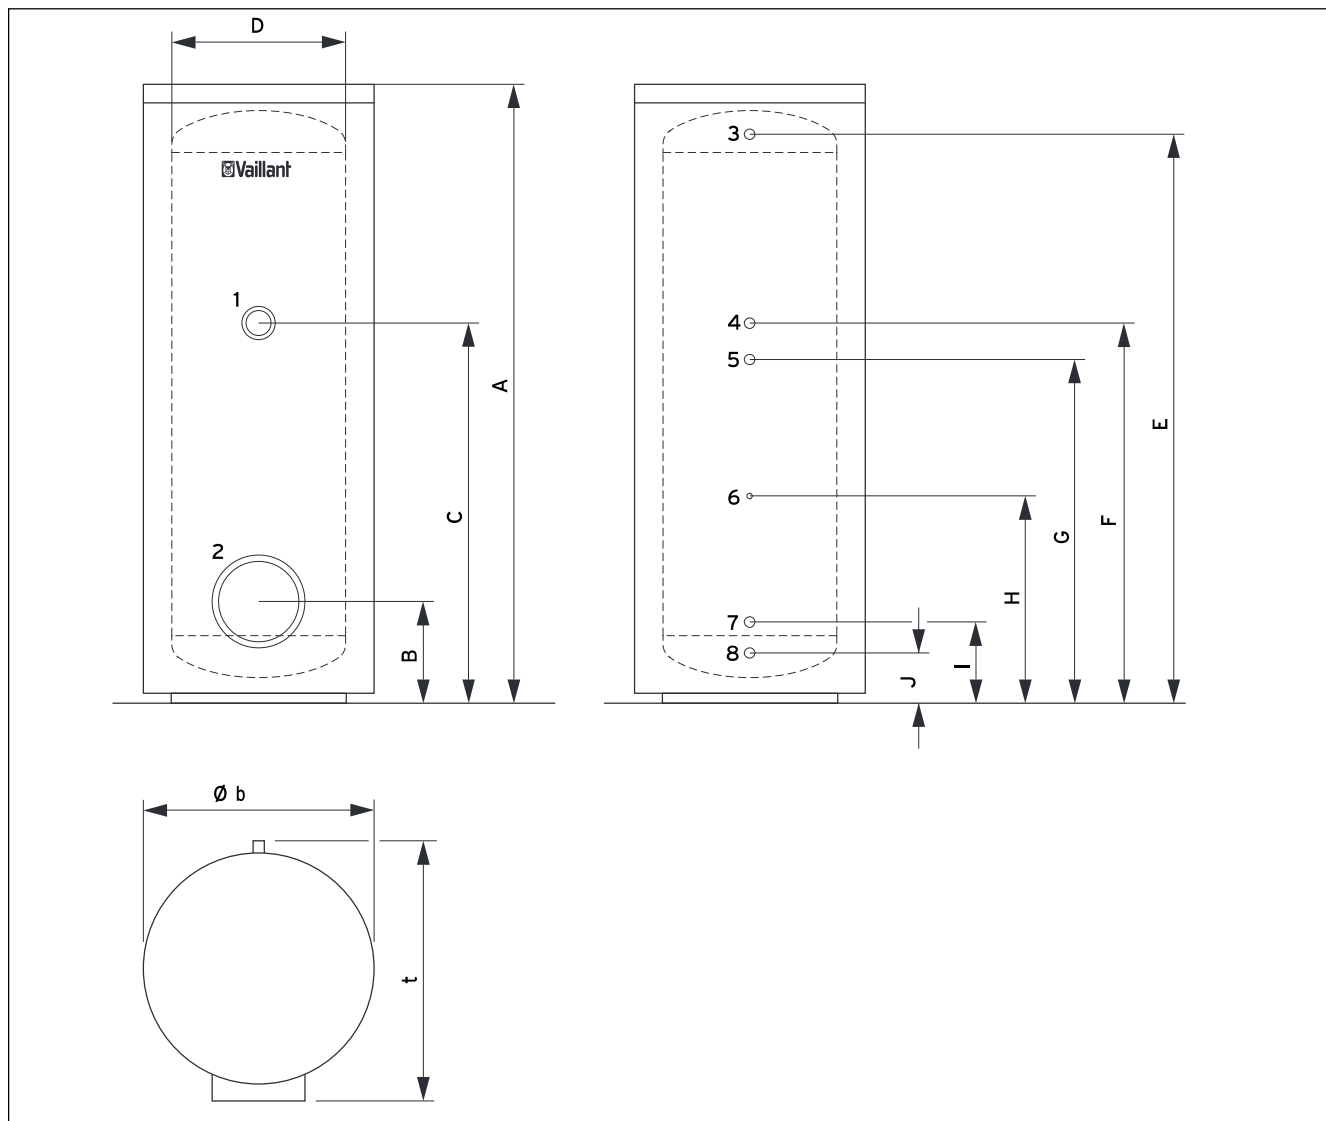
Dimensions de l'appareil et des raccords VIH R
